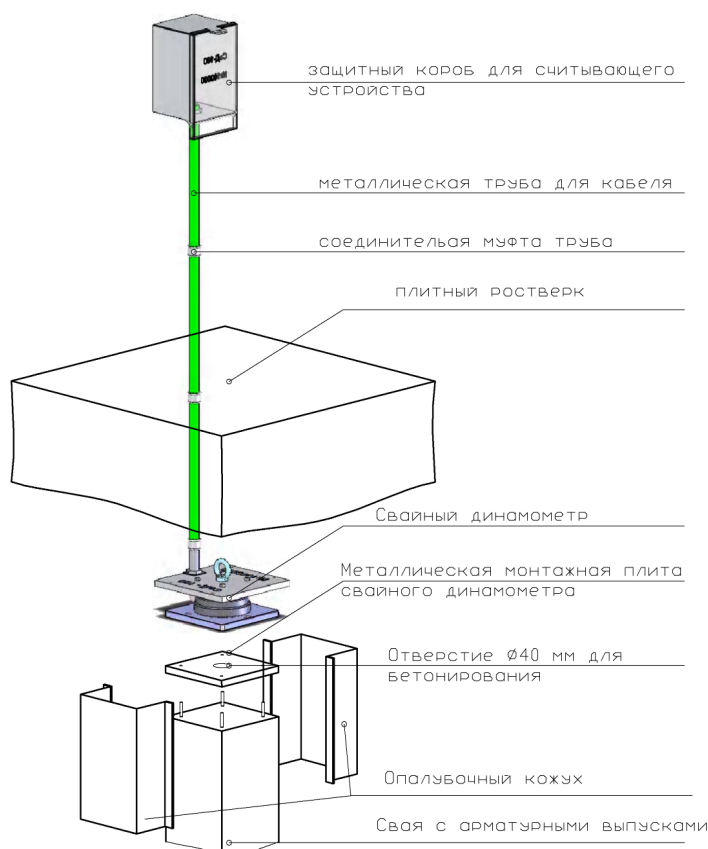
Общая схема крепления и основные узлы свайного динамометра СвД-100
